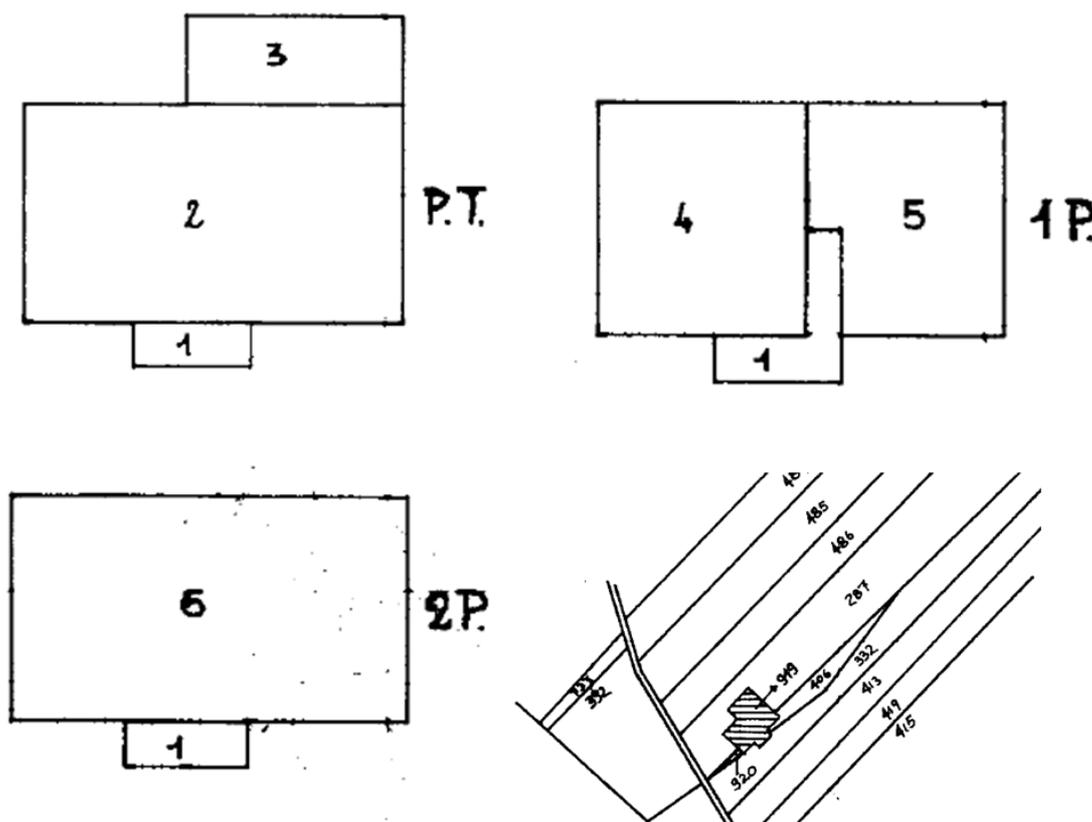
Stralcio dell'elaborato planimetrico risalente al 1995 (ultimo in atti alla data della perizia Liuzzi)
